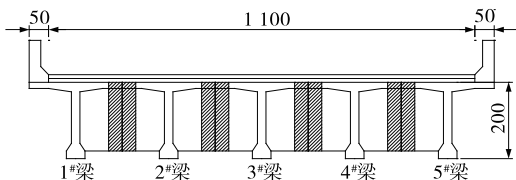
某斜梁桥典型横截面布置示意图(单位:cm)
